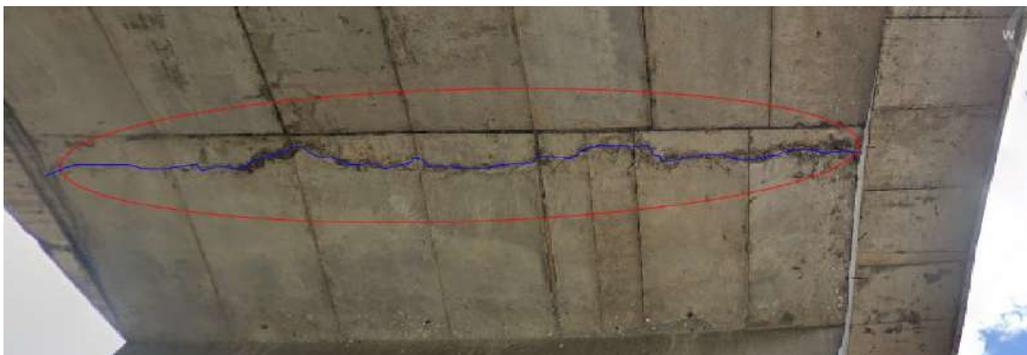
Puente vehicular (Calle 92) - Presencia de fisuras en el tablero del puente
